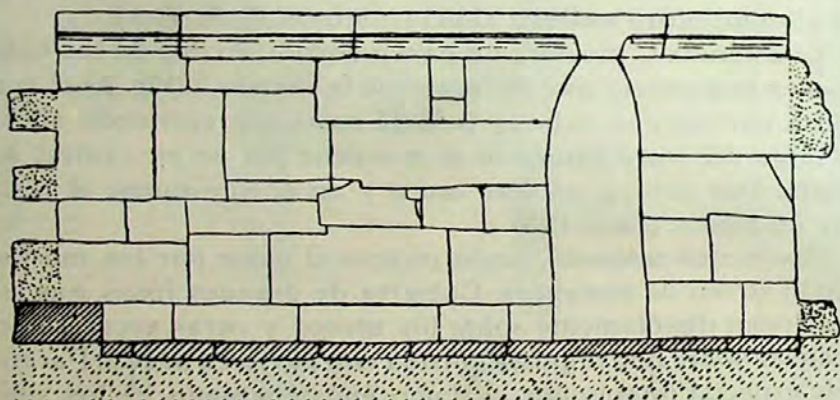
<sup>a</sup> - b) Paramento del muro derecho de la cámara central.
